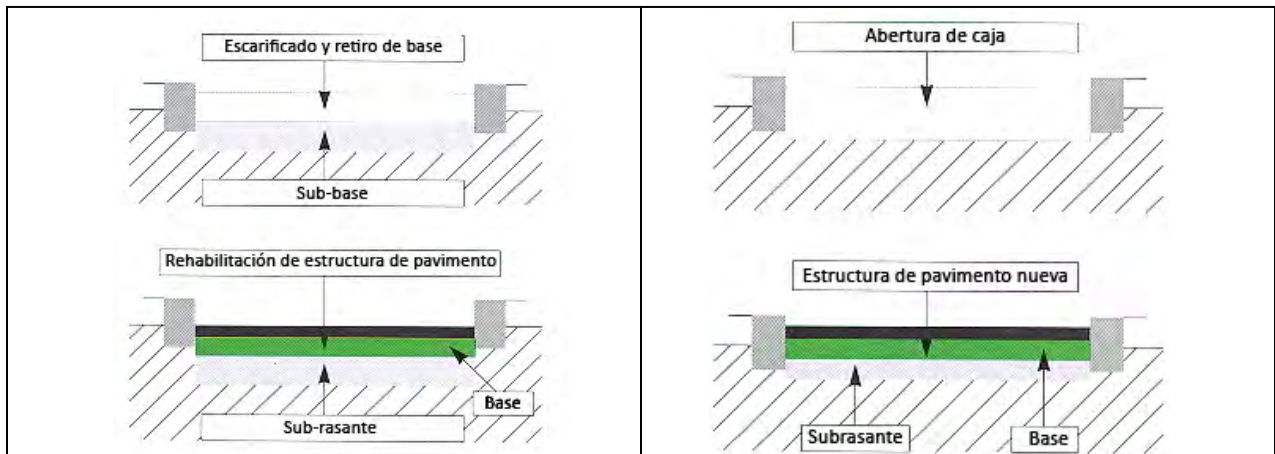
EJECUCIÓN aplicable a obra de rehabilitación previo trabajo de escarificado de asfalto para su reciclado.
